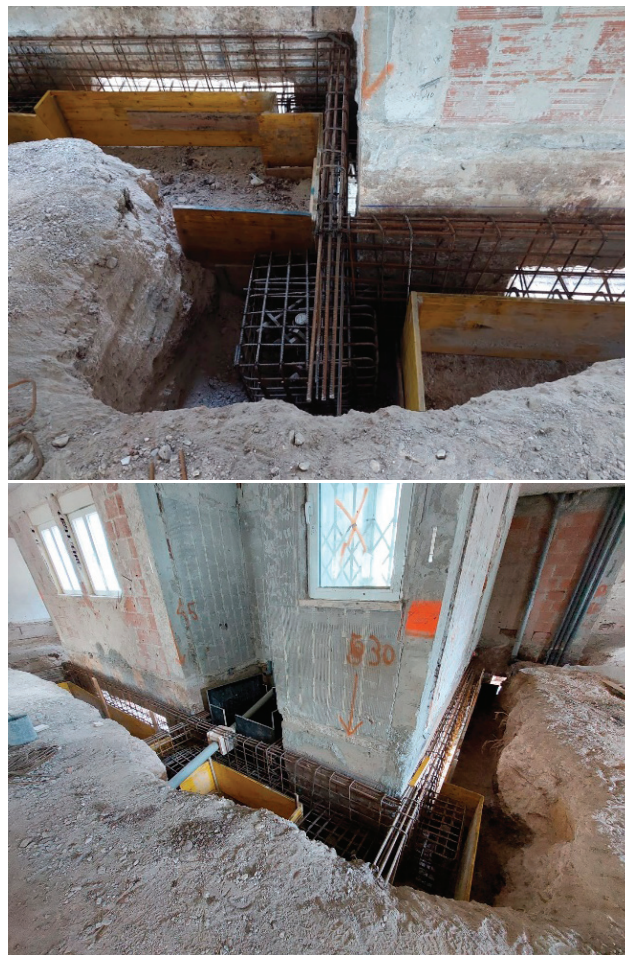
Colocação da armadura do maciço e das vigas de fundação para execução
